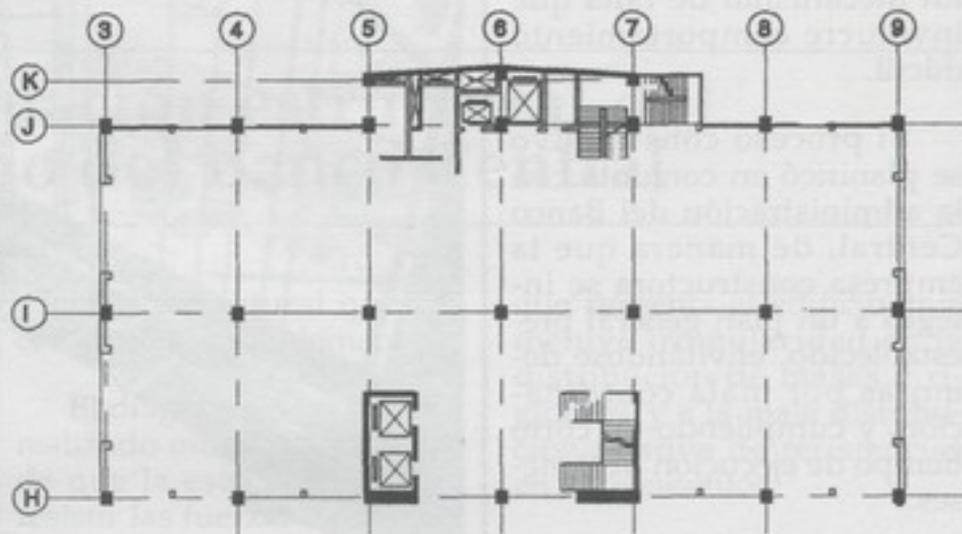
PLANTA DE NIVELES 4, 5, 6, 7 Y 8
